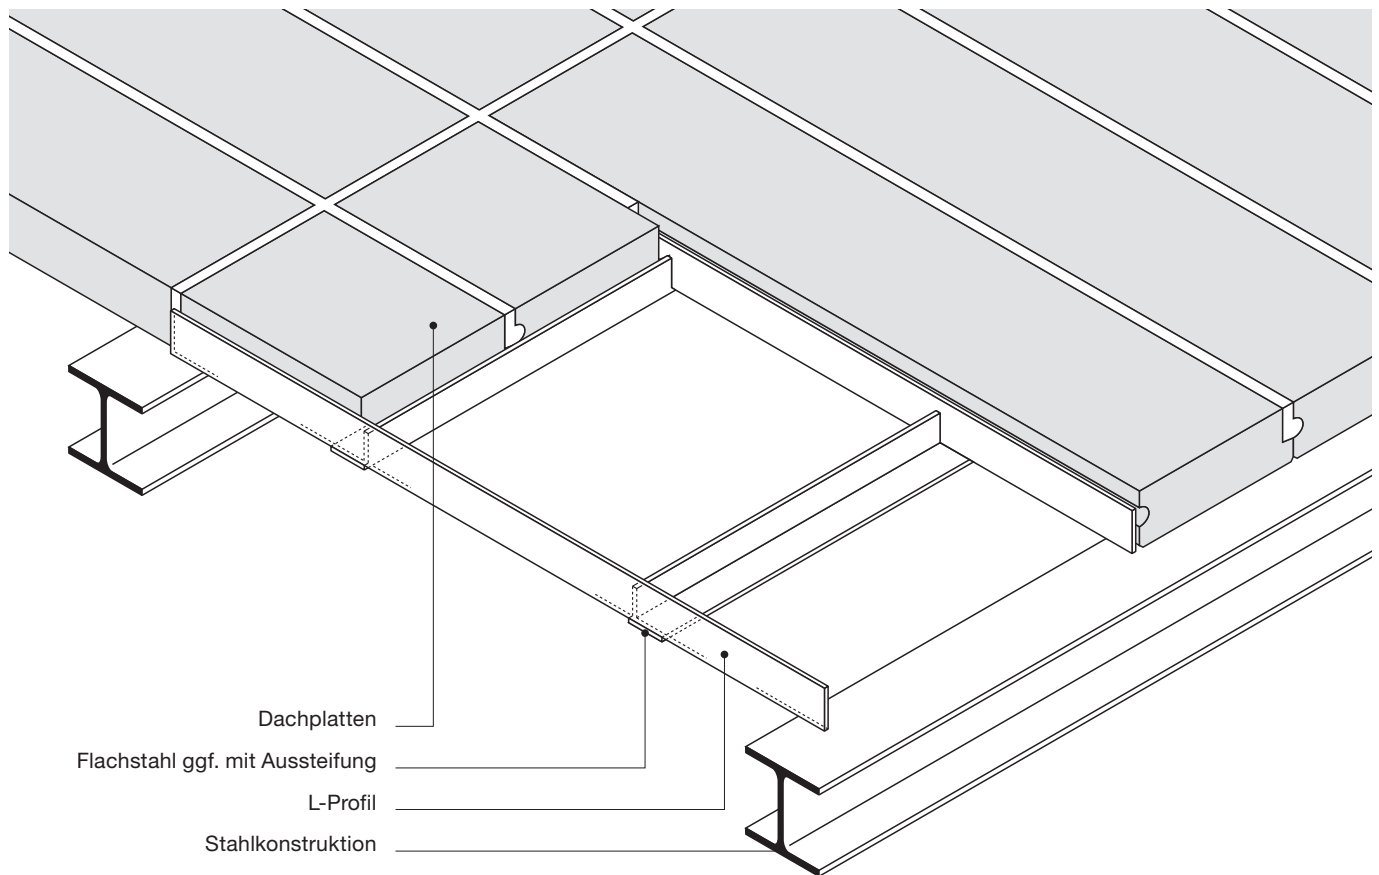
Dach mit Auswechslung durch einen Stahlrahmen
